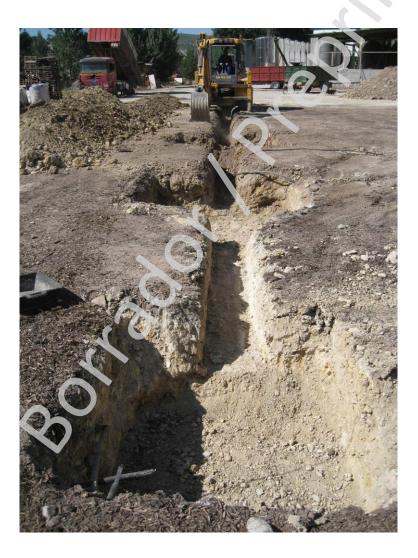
Zanja y zapatas de cimentación en el lateral sur
